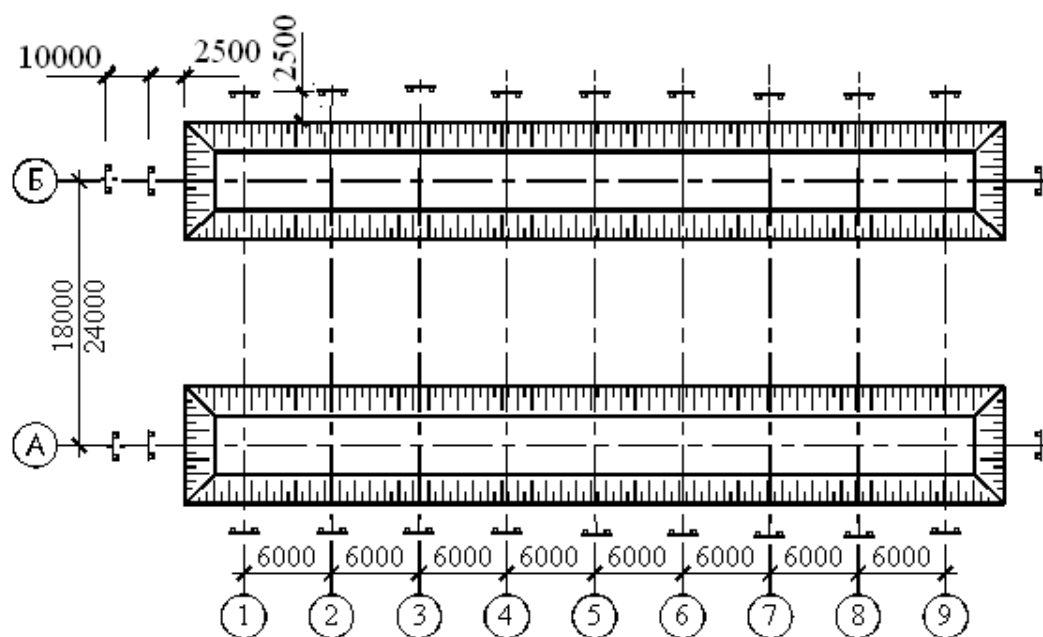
Схема устройства траншей под фундаменты здания при пролетах 18 и 24 м
